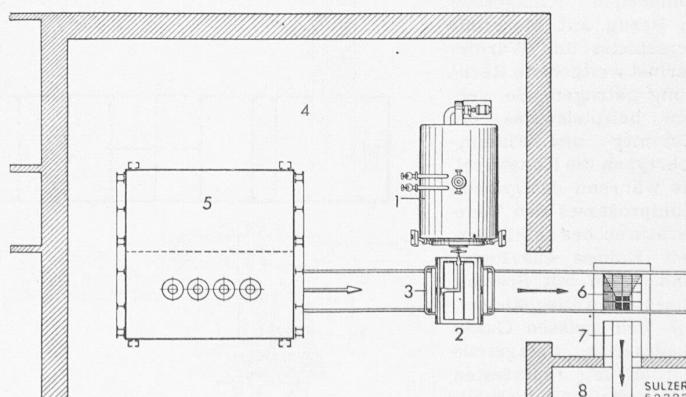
Schematischer Grundriss. 1 Kühlanlage, 2 Kokskübel, 3 Transportwagen, 4 Ofenhaus, 5 Vertikalkammerofen, 6 Koks-Entleerungsgrube, 7 Schrägaufzug, 8 Sortieranlage
